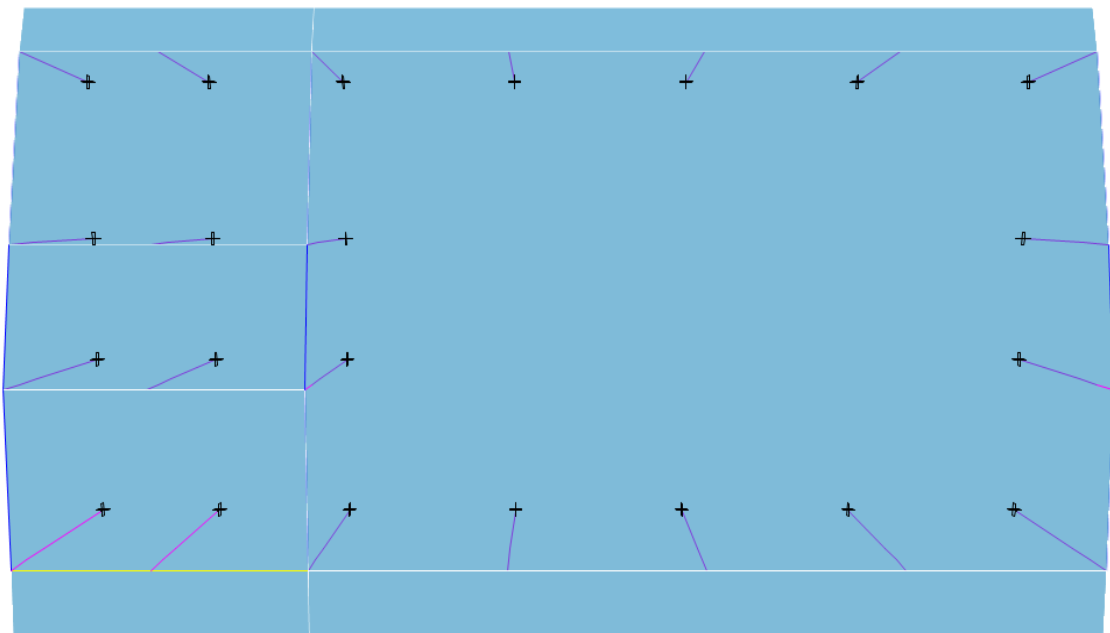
Vista en planta y 3d modelada (Edif . N° 03 – Gimnasio)
